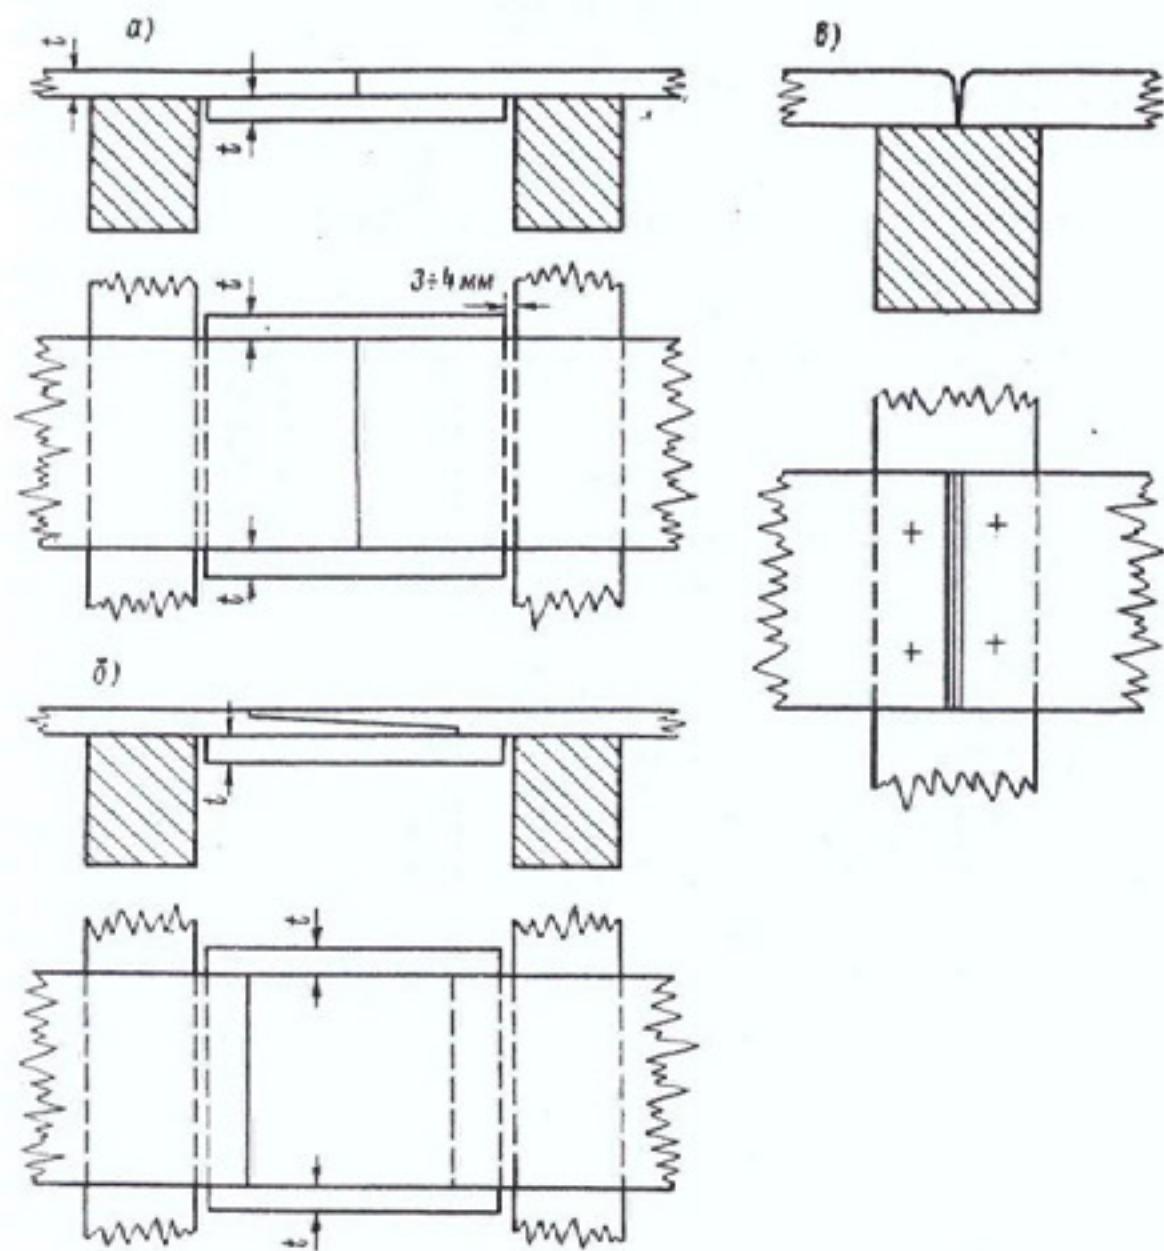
Стыки досок обшивки: а — в прирезку на стыковой планке; б — косым замком на стыковой планке; в — в разладку (под конопатку).
